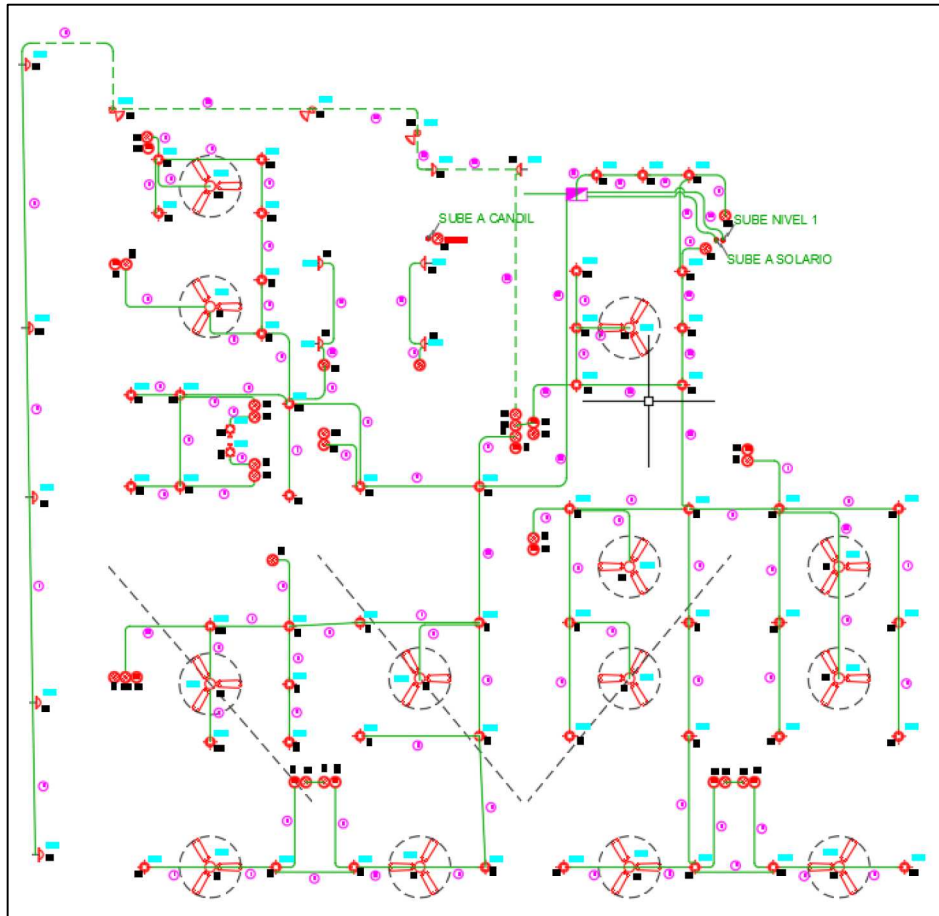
Plano de distribución eléctrica planta nivel a calle.
